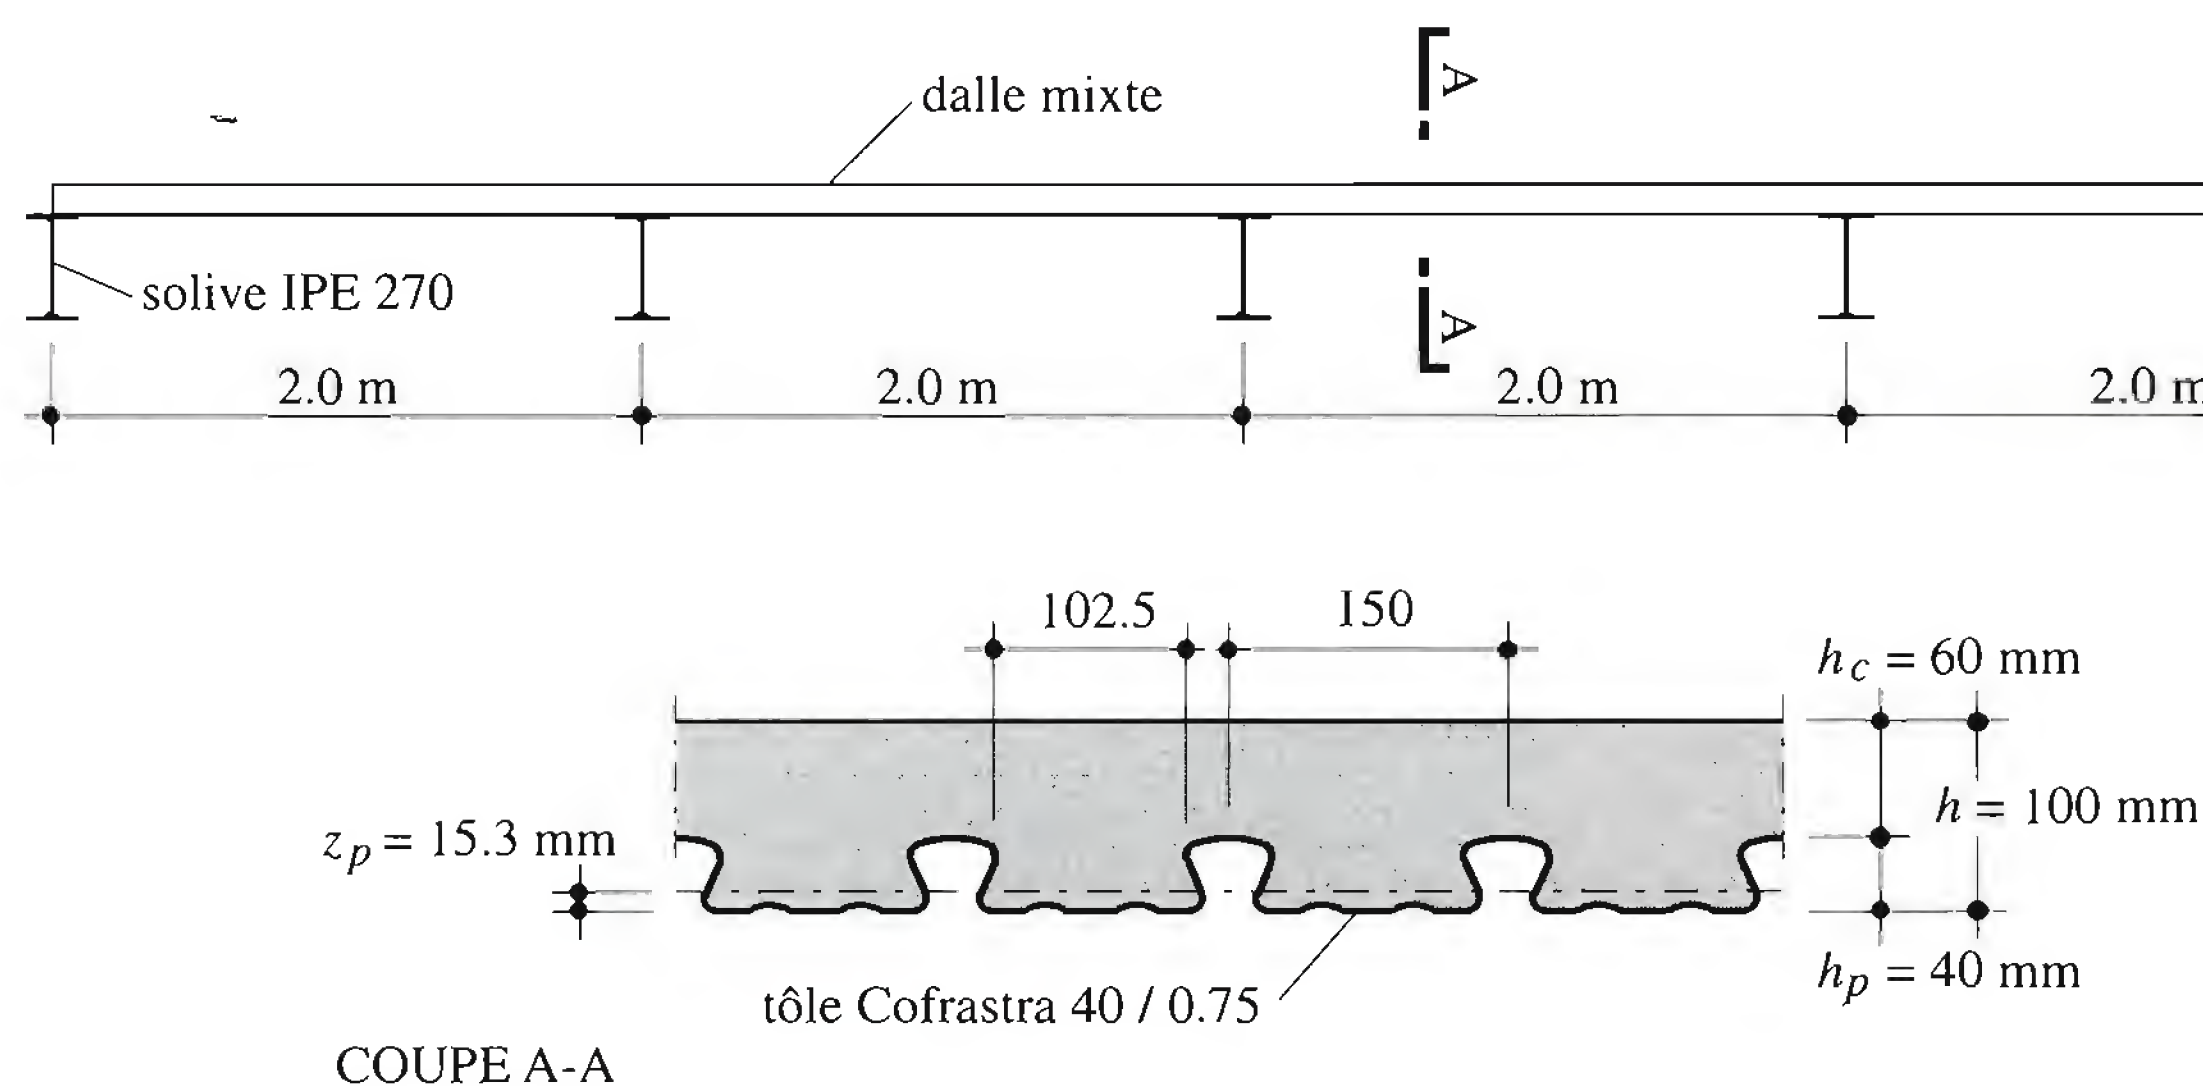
Dalle mixte à vérifier (locaux habitables).
